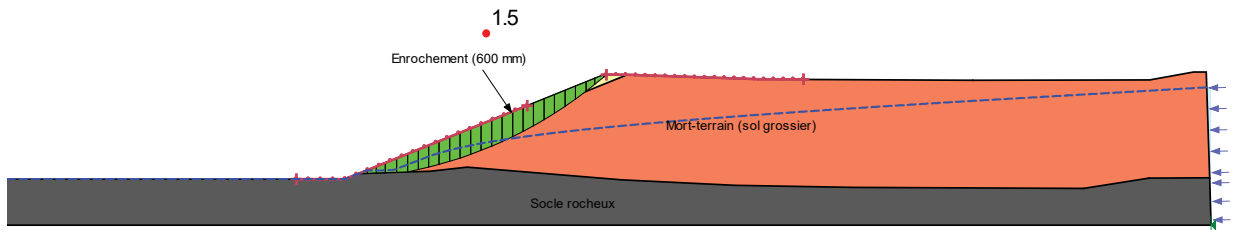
Stabilité long terme avec une couche d'enrochement de 600 mm, excavation dans des sols grossiers
